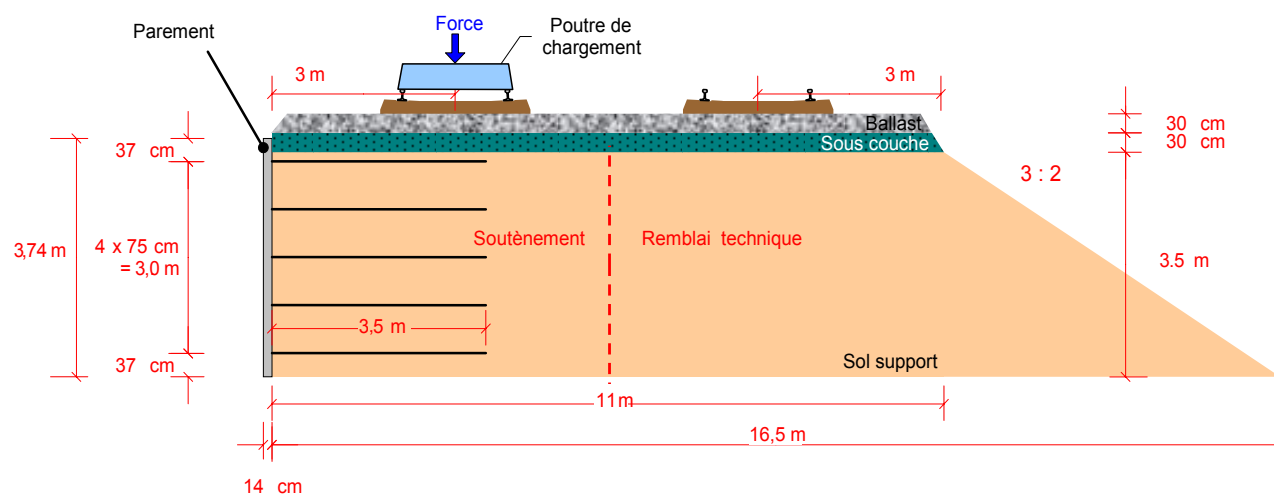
Coupe longitudinale de l'ouvrage expérimental (d'après Froumentin et al., 2008).
